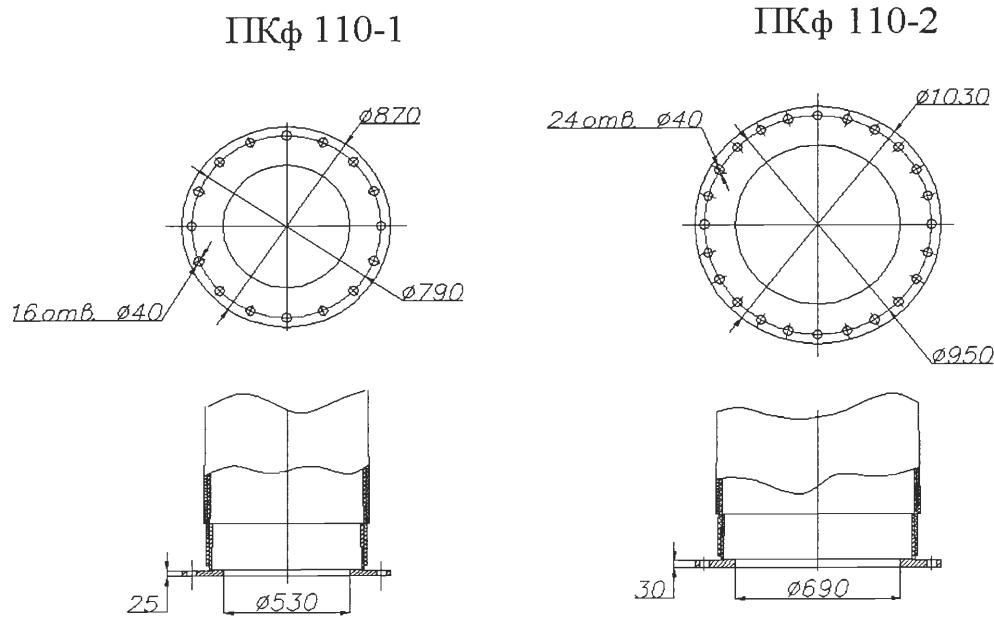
Фланцевые соединения для установки на фундамент композитных опор ПКФ 110-1, ПКФ 110-2.
